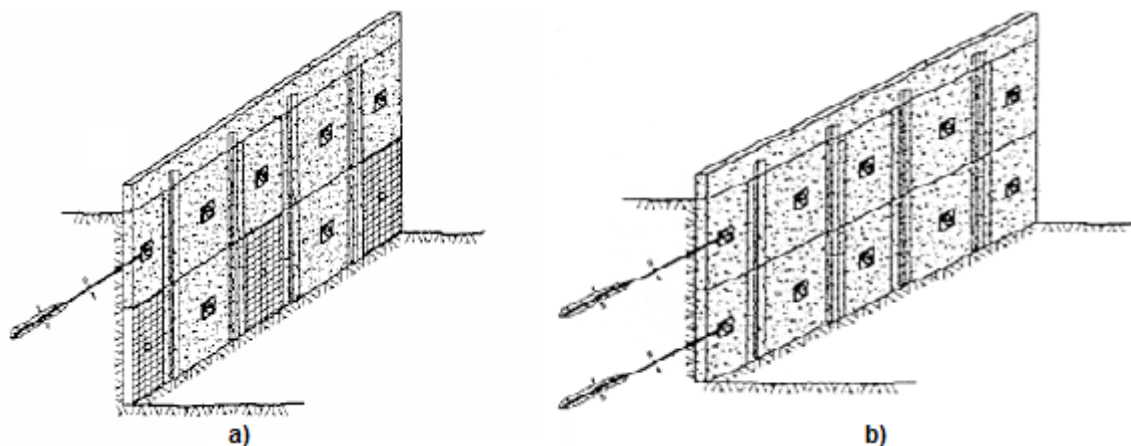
Execução do nível seguinte: a) painéis primários construídos e armadura dos painéis secundários executada; b) fim da construção dos painéis do nível e tensionamento das ancoragens [45]
